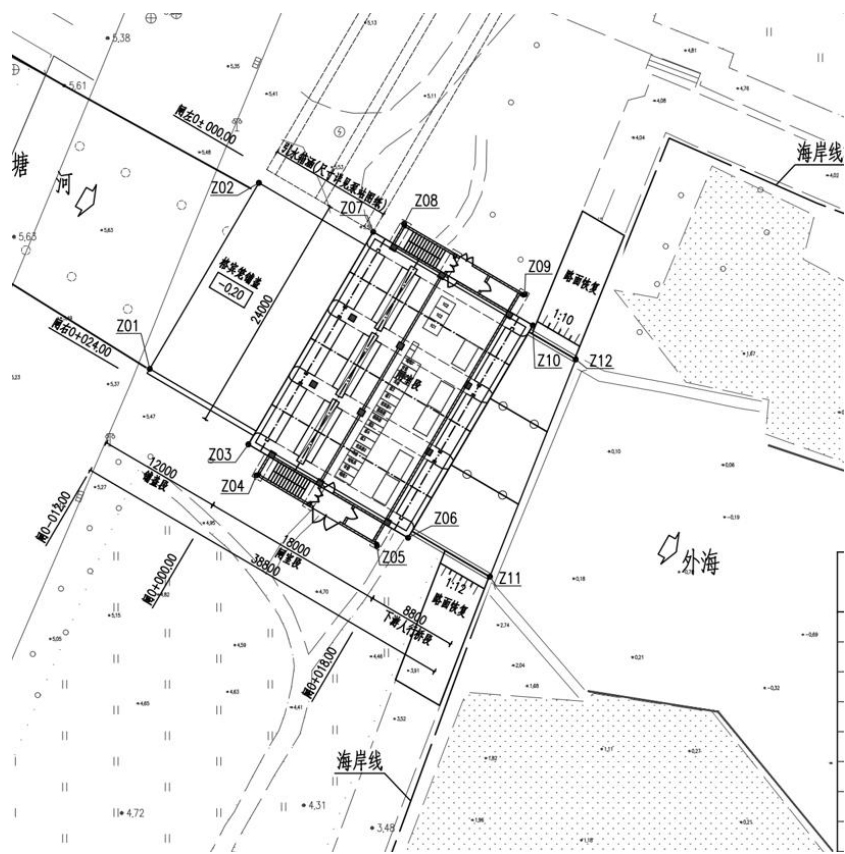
绿塘河挡潮闸总平面布置图（局部放大图）
